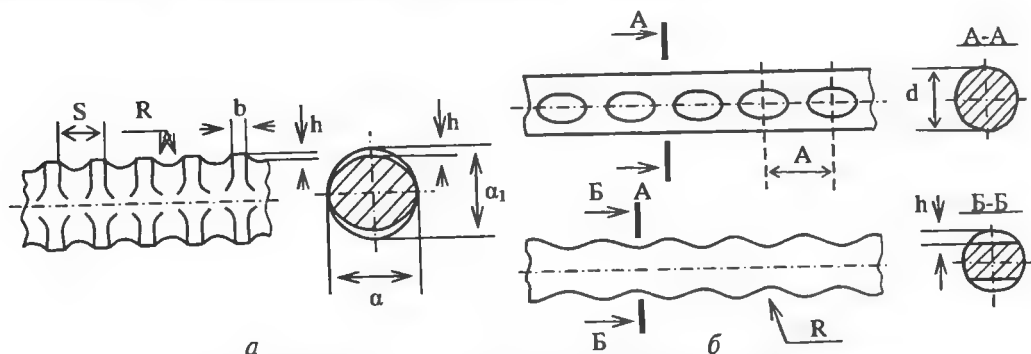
Профiлі дроту для армування залізобетонних конструкцій:
